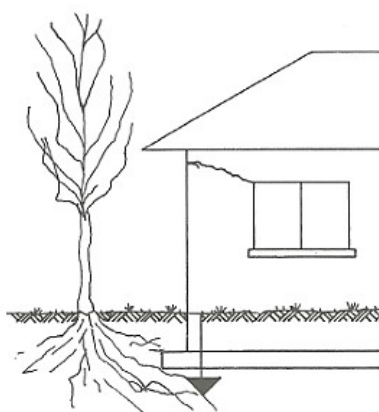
Fissura causada por infiltração devido à vegetação próxima.
